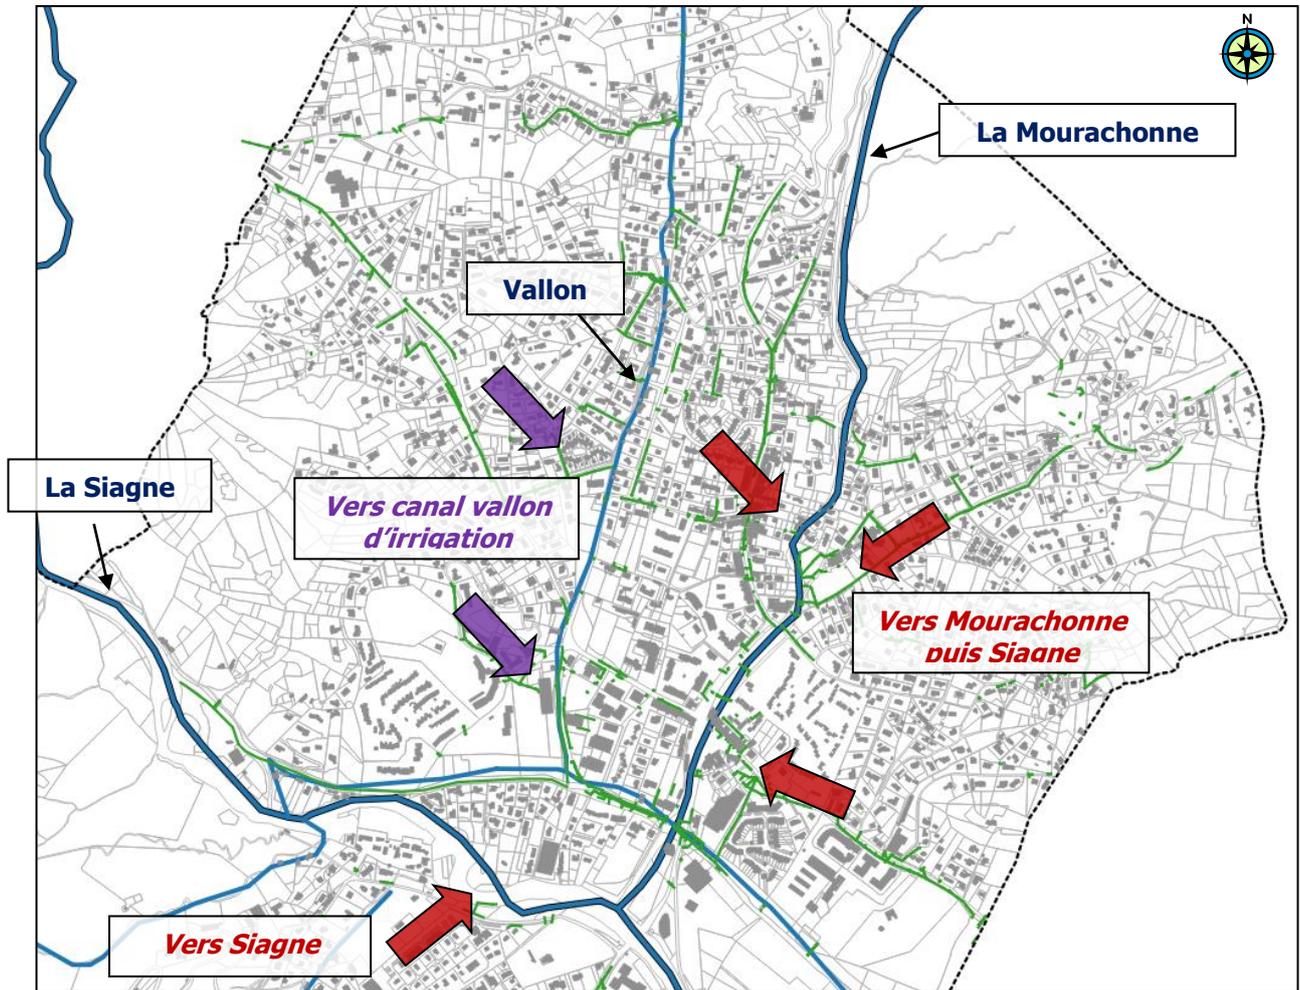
Extrait du plan de réseau : exutoires des réseaux EP
